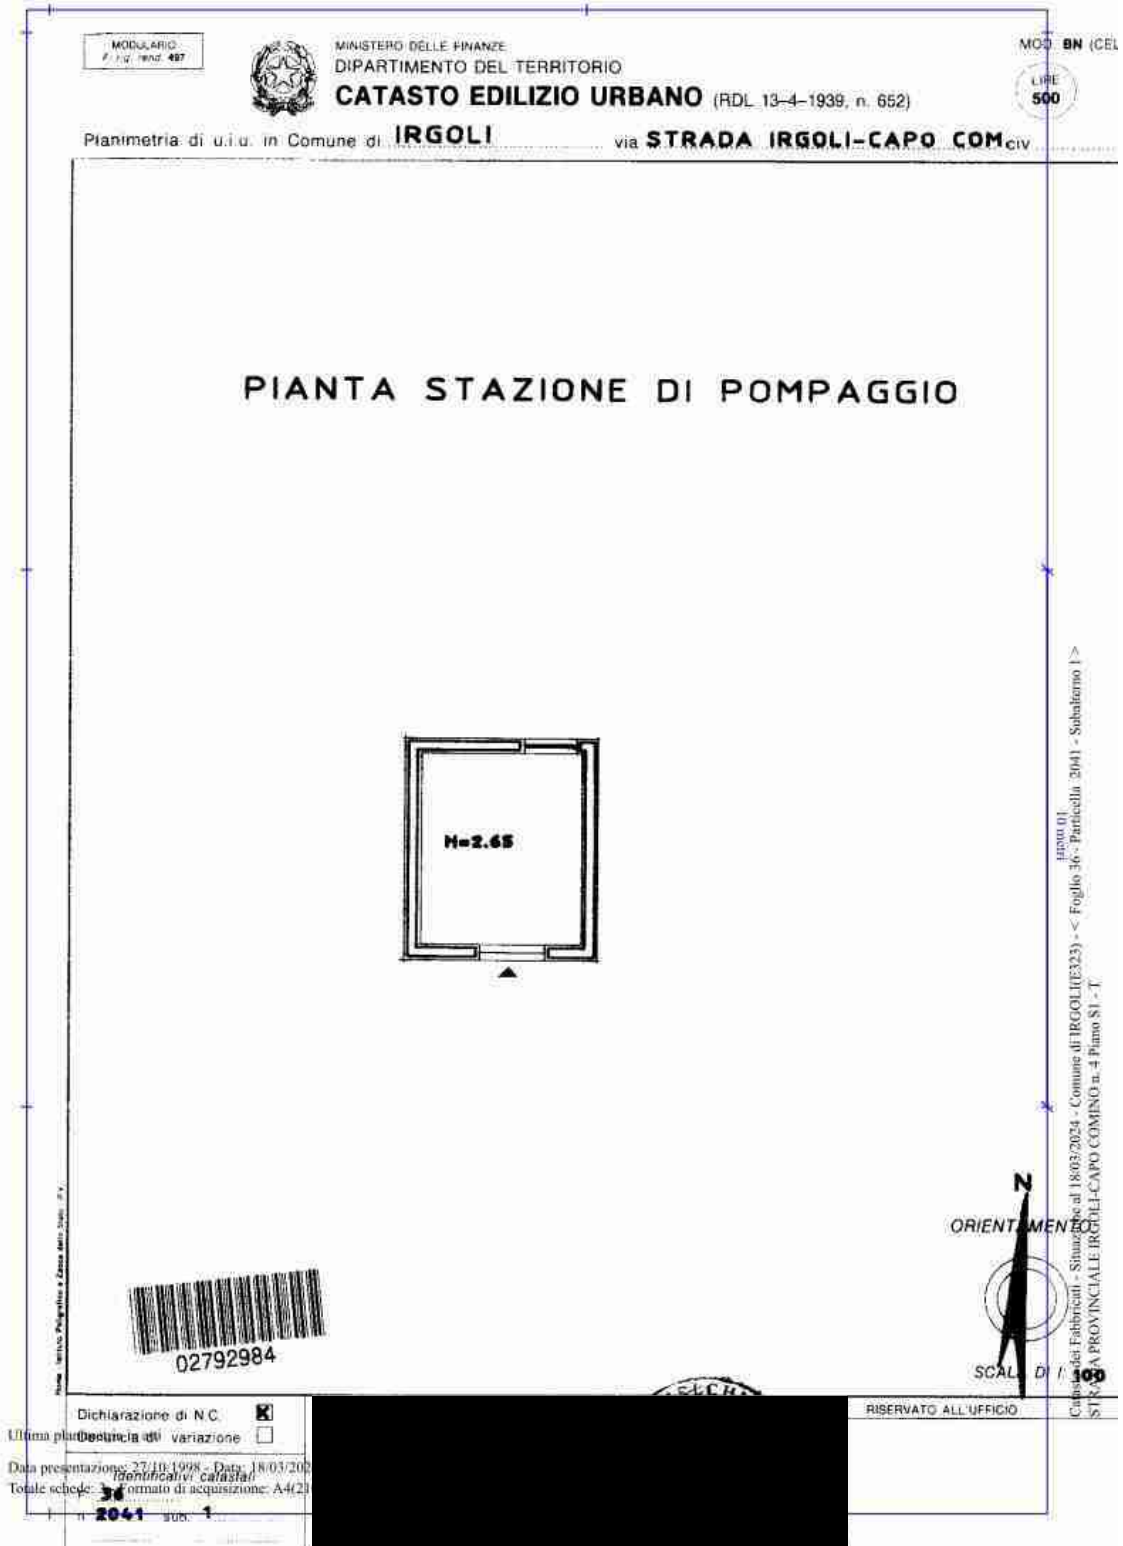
\_planimetria catastale del f.36 p.Ila 2041 sub.1/parte (stazione di pompaggio antincendio)
